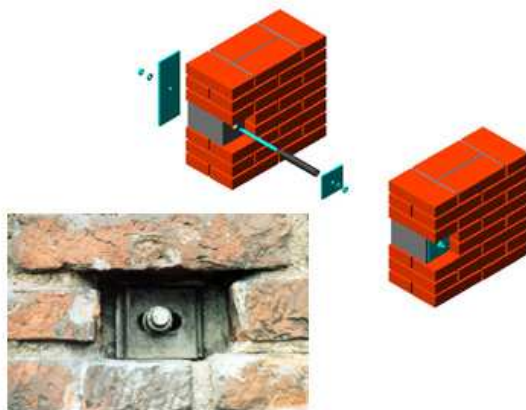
Confinamento della muratura tramite tiranti inseriti nelle buche pontae: schema e vista dall'esterno della piastra inox di ancoraggio. Figura 3 La “torre nella torre” vista dall'interno, particolare dei pendini e degli anelli perimetrali.
